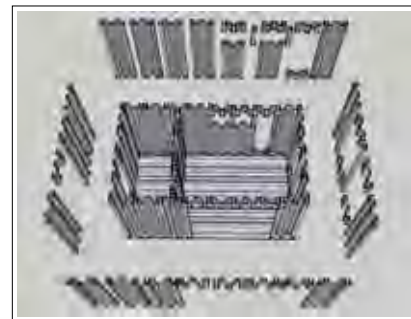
Módulo A. Detalle: Elaboración propia 2010
